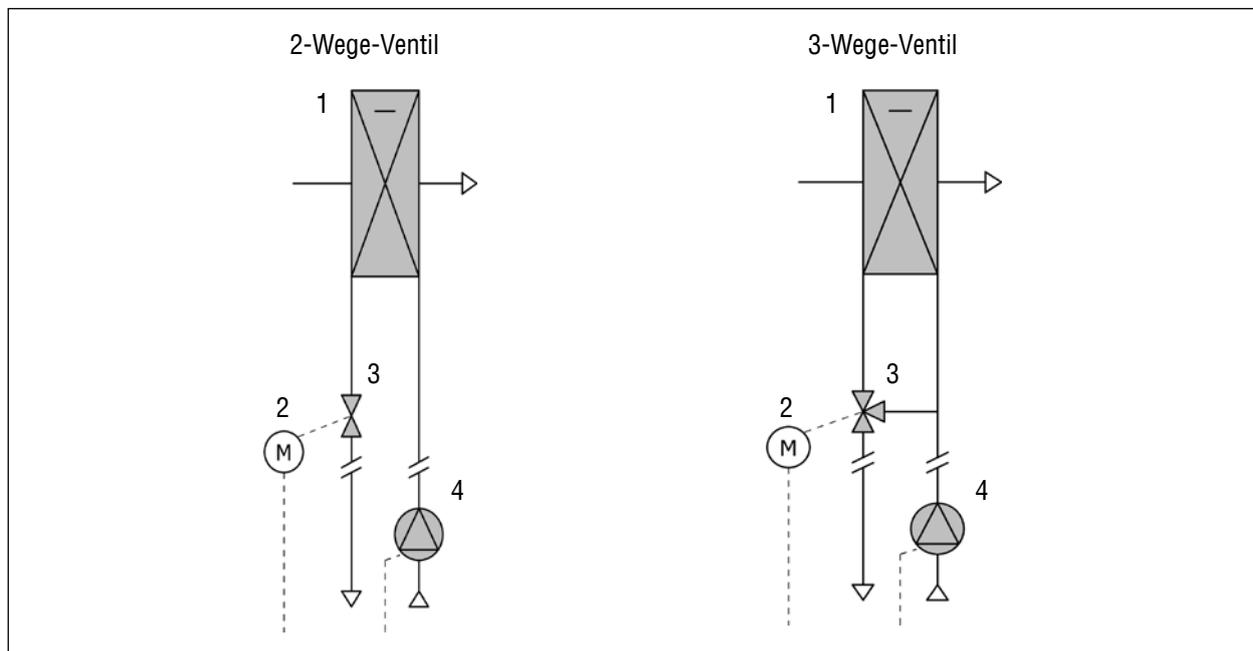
Anschlussausführungen mit 2-Wege-Ventil und 3-Wege-Ventil
